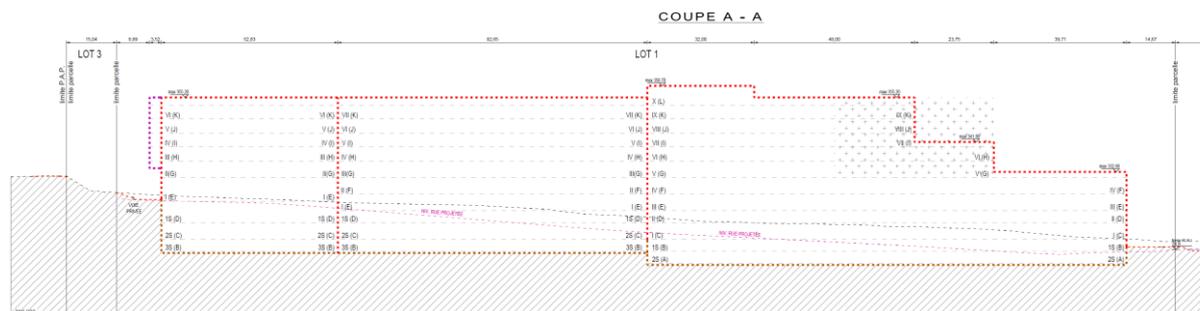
Coupes sur le bâtiment du lot n° 1 (Source : BEST)
